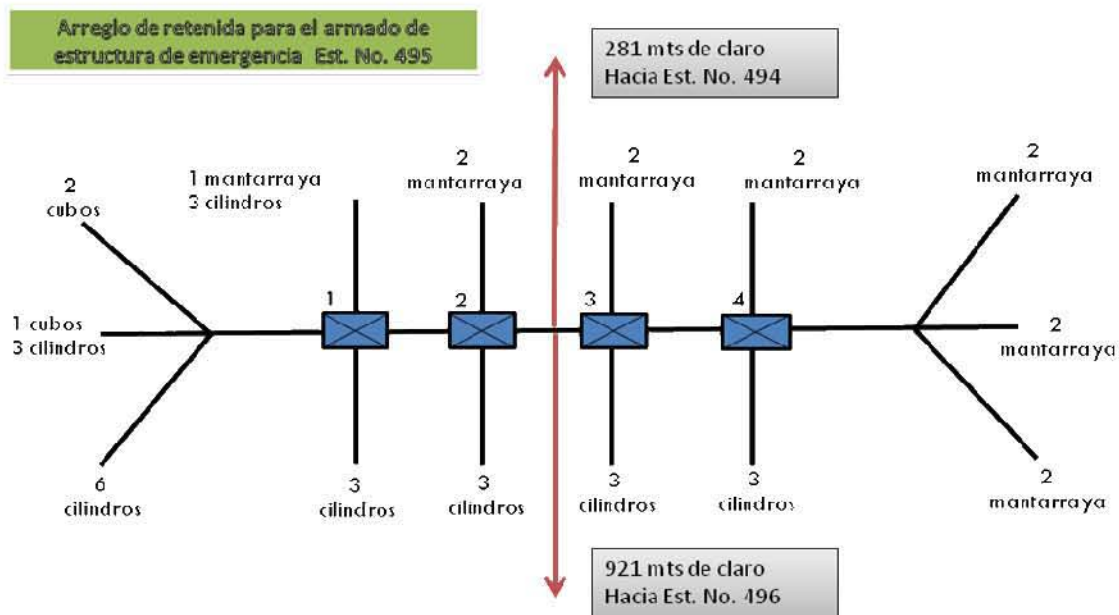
Diagrama esquemático de la ubicación de retenidas para la estructura de 4 columnas
